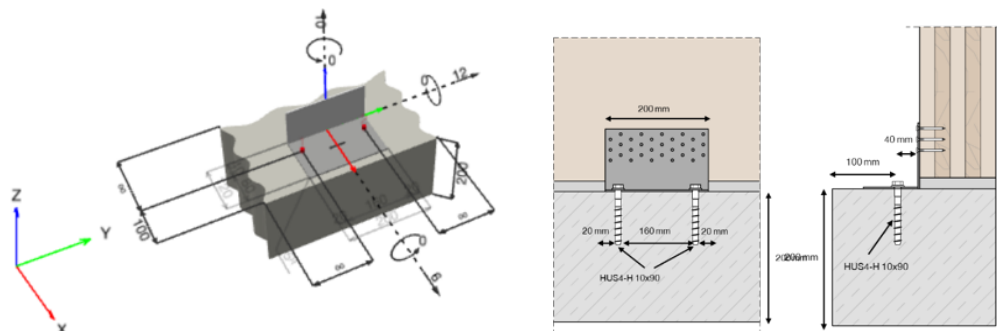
Befestigung einer Holzwand an einer Betonplatte mittels Winkelverbinder: PROFIS Engineering-Modell und Skizze der Anschlussgeometrie
